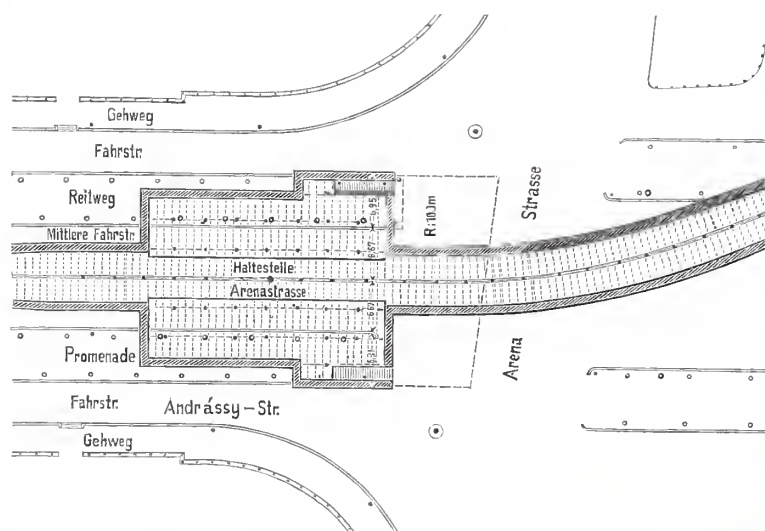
Grundriss der Haltestelle Arenastrasse.
